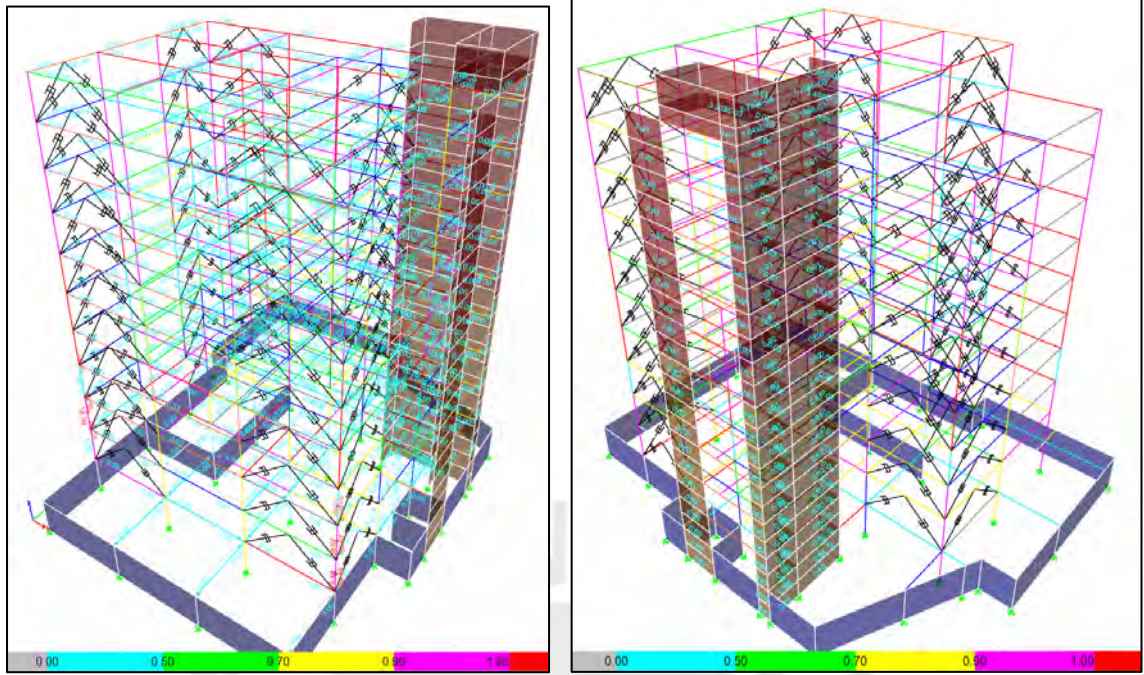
Imágenes de las vigas, columnas y placas para Prevención de Colapso
